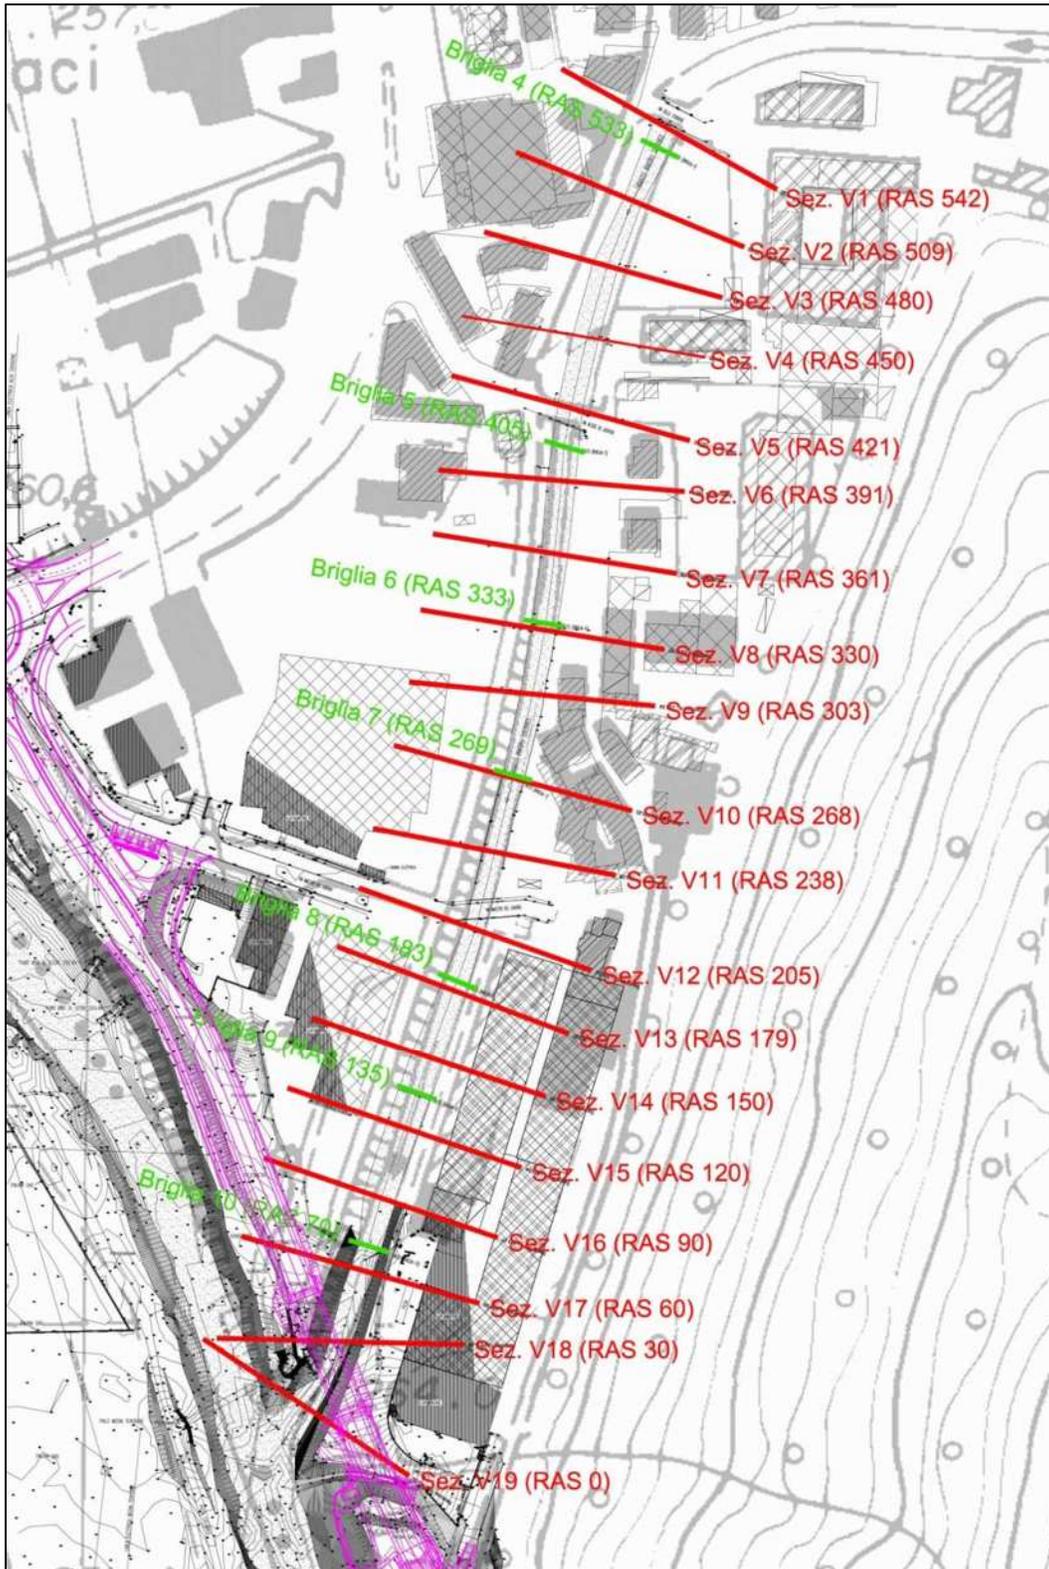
T. Faidana (Tratto Sarezzo) – Planimetria sezioni rilevate e indicazione sezioni RAS
